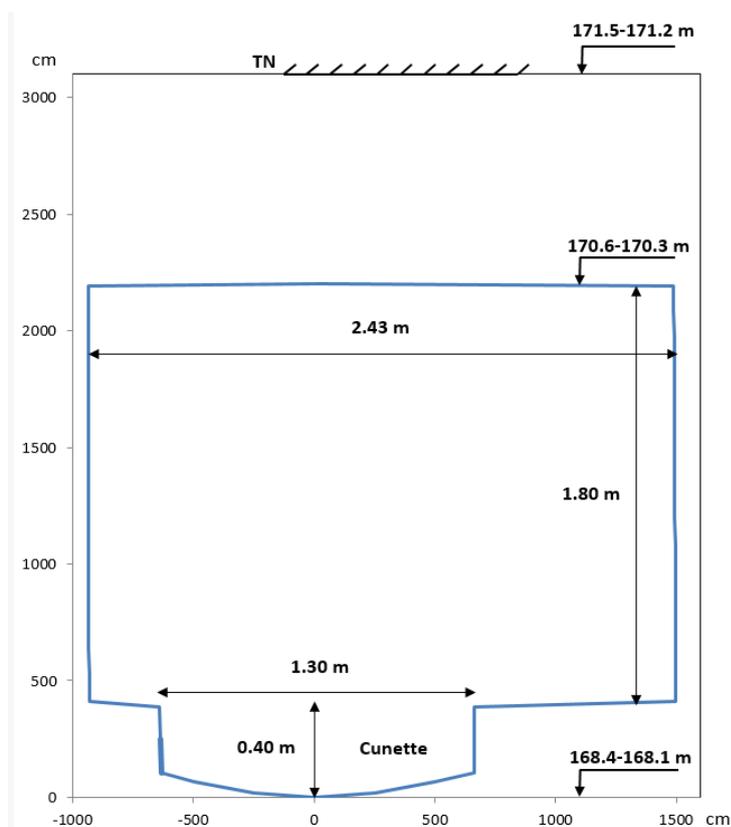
Section du collecteur unitaire structurant « 59A » route de Trévoux
